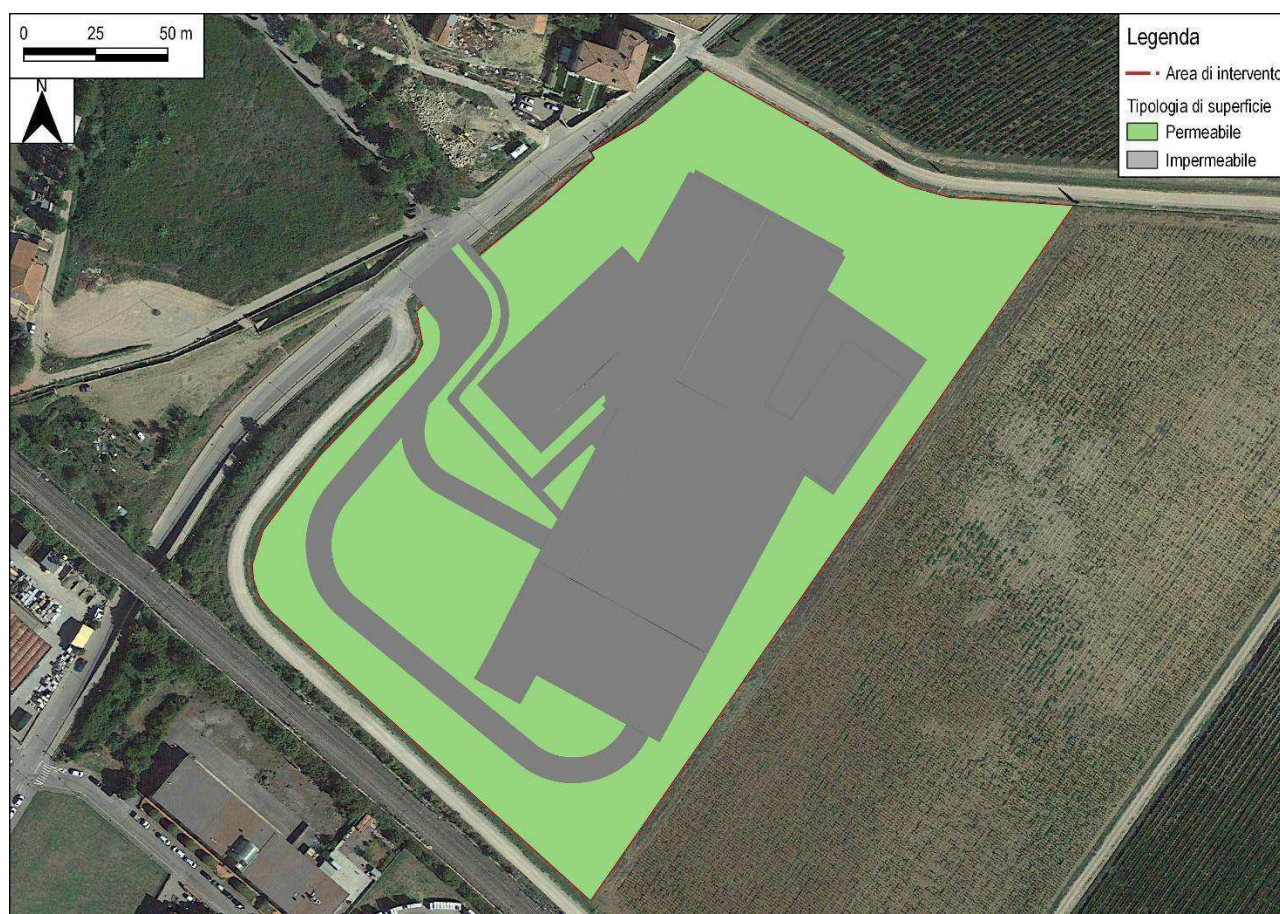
Individuazione delle aree permeabili ed impermeabili
